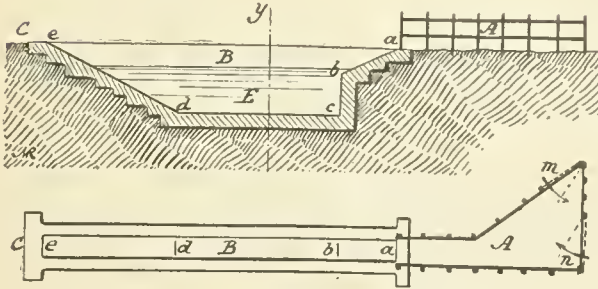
Coupe longitudinale et plan du bassin pour l'immersion des bœufs.
